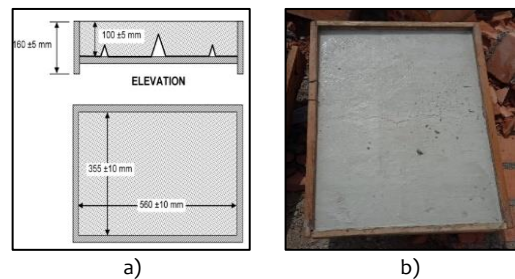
Dimensiones del Panel o Molde para el Ensayo y Control de Fisuras en el Concreto Simple con $f'c=210$ kg/cm². a) Panel (molde) Normado por la ASTM C1579 - 13. b) Panel de Madera con Concreto Previamente Ensayado.
